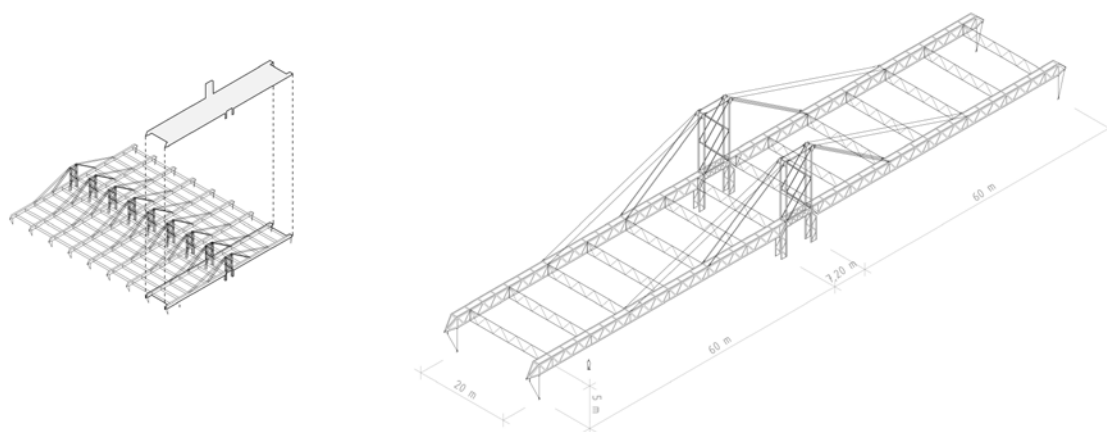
Axonometría y módulo estructural. Fuente: Elaboración propia.
